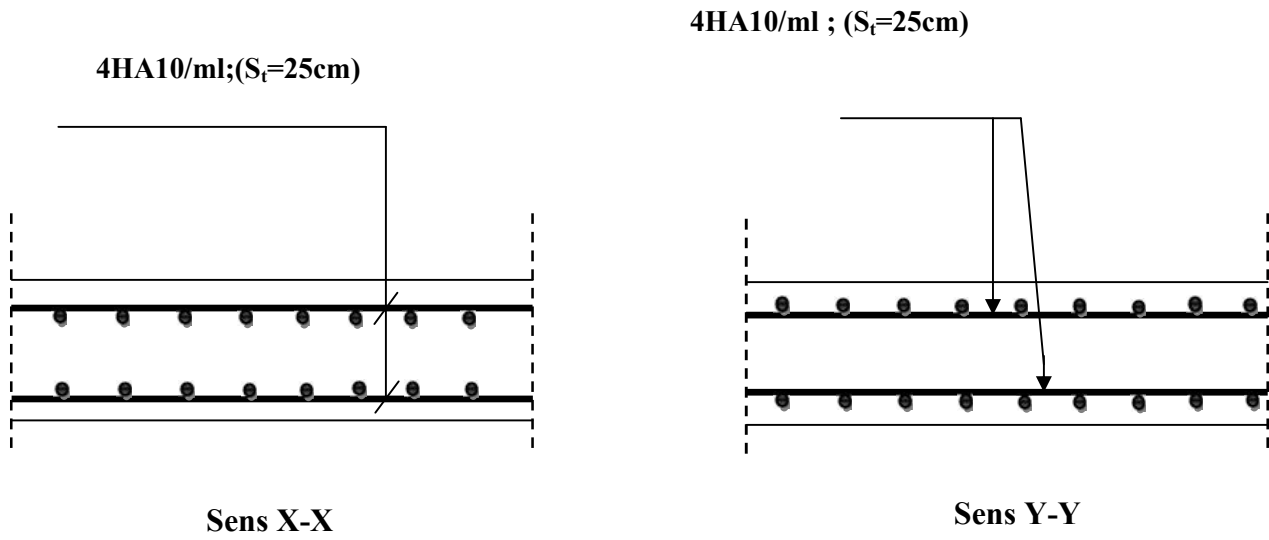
Ferrailage de la dalle pleine de la salle machine.
